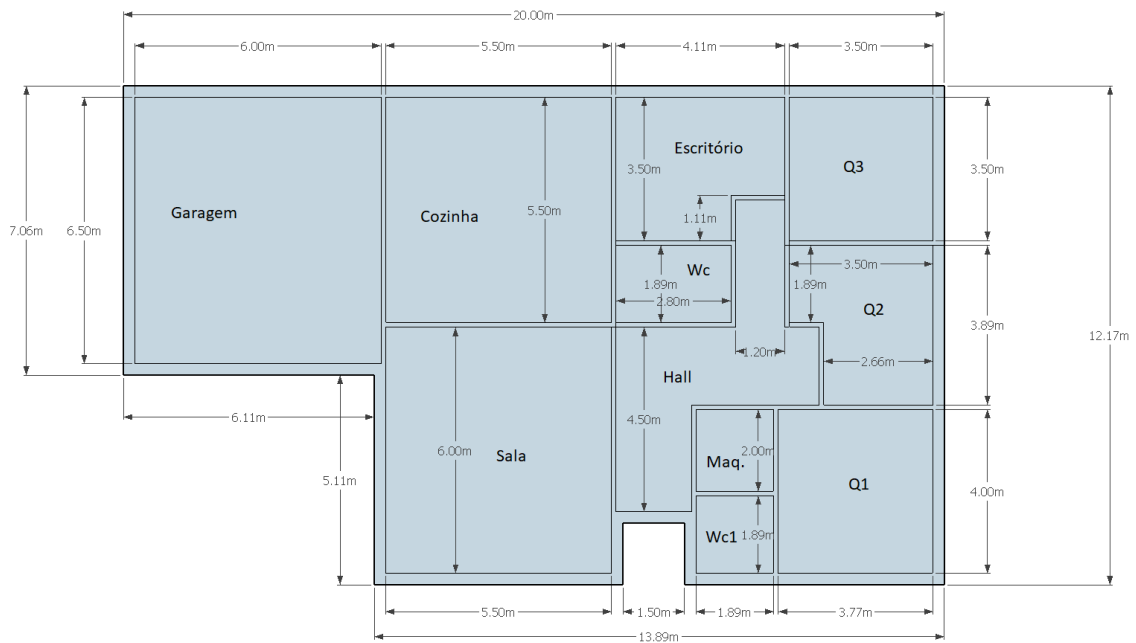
Planta base para teste de cenários do Projeto 2.
